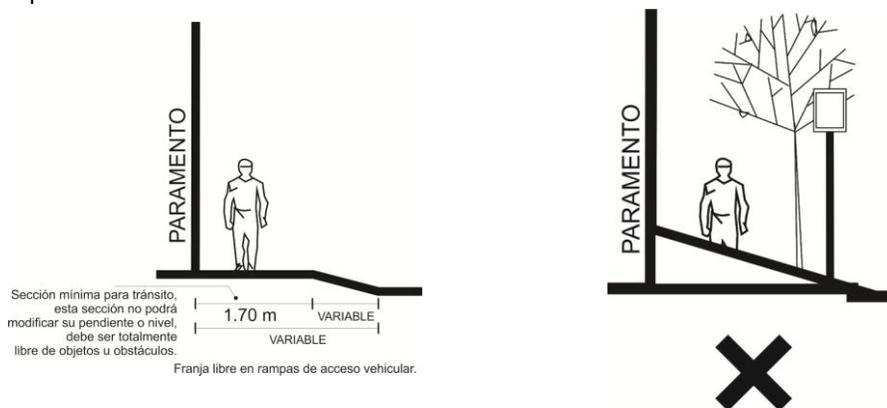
Esquema de rampas vehiculares sobre banquetas
